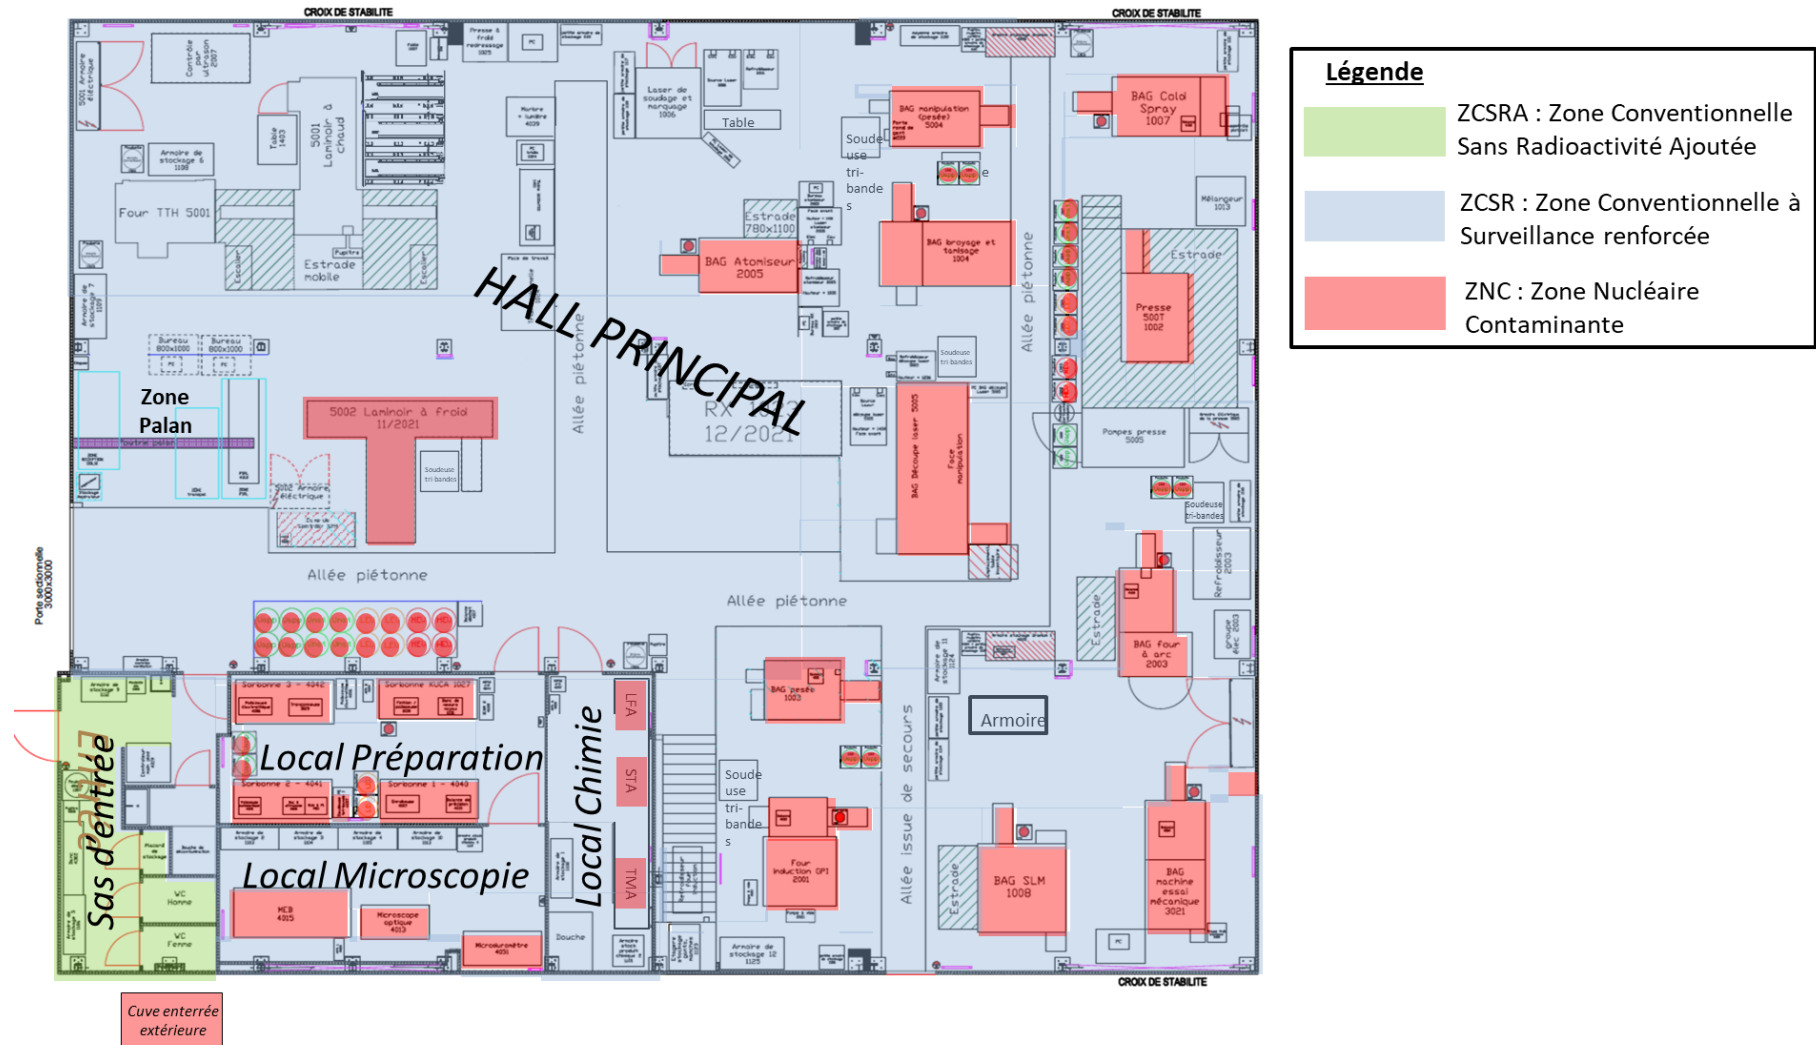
Zonage Déchets du Rez-de-Chaussée du bâtiment EX 3
